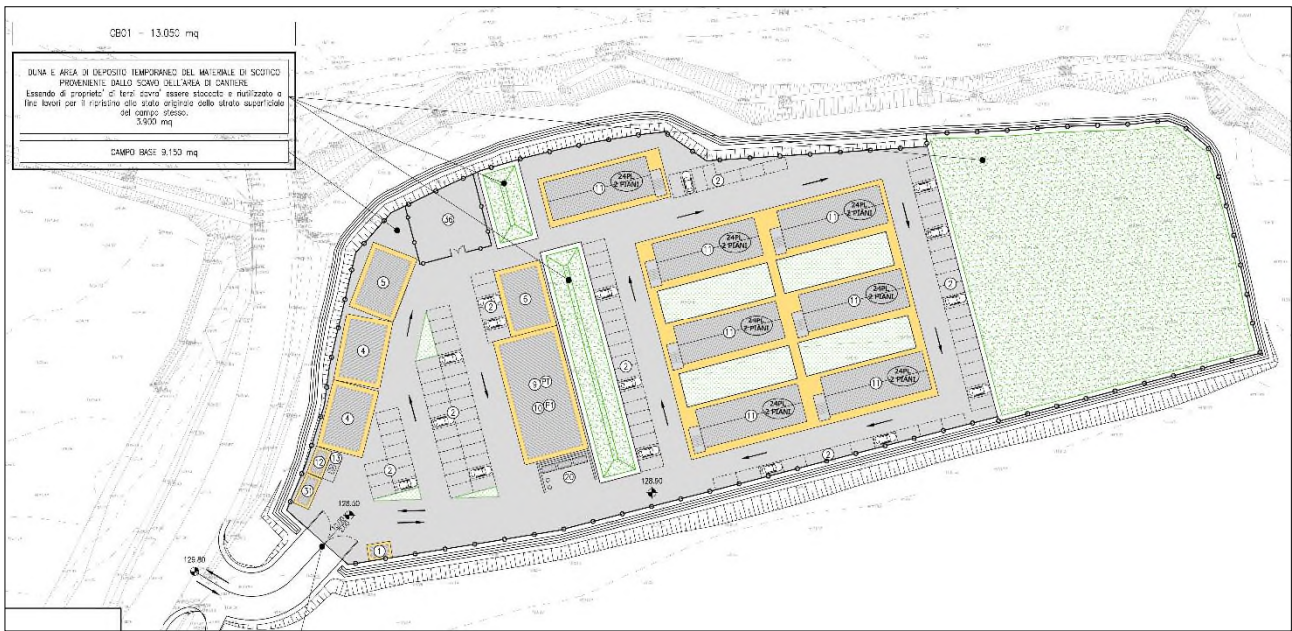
Stralcio planimetrico dell'area di cantiere CB01, nel Lotto 1
